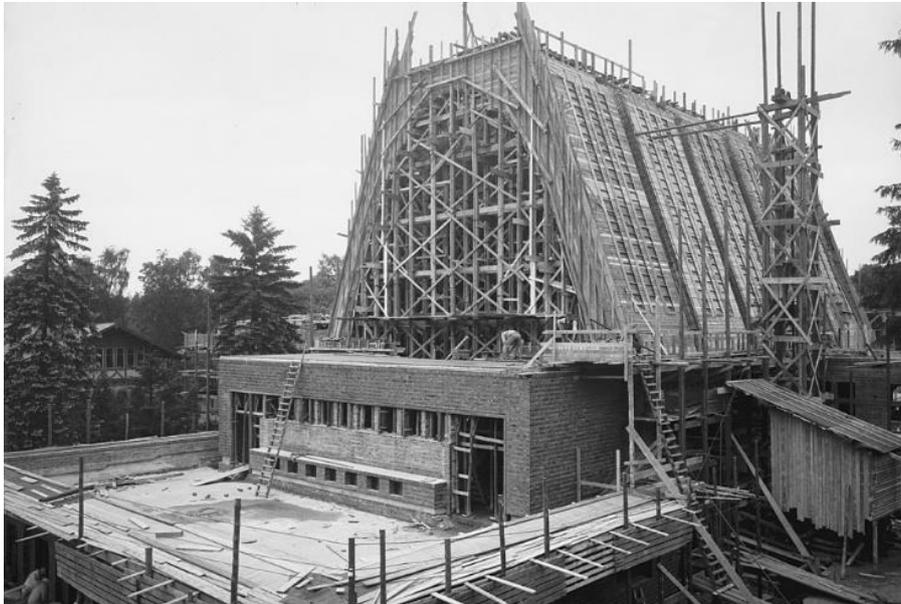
Proceso de construcción de la sala principal con hormigón armado.
